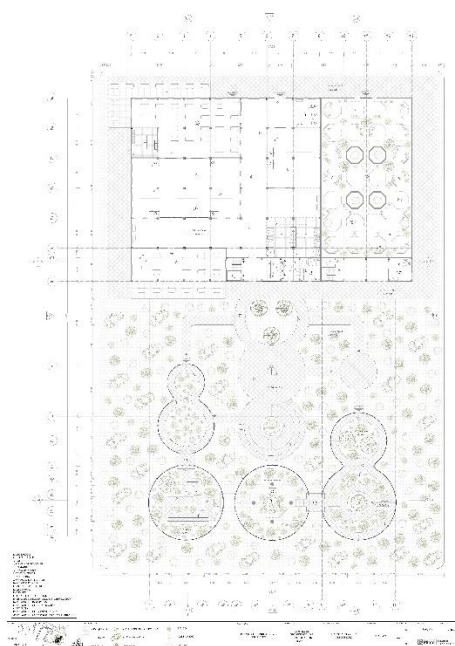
Planta segundo nivel del proyecto. Elaboración del autor (2024).
